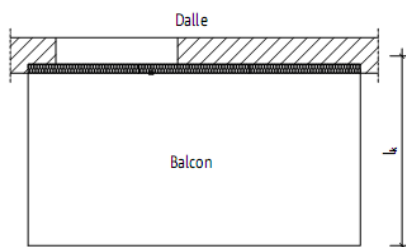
Balcon en béton armé en porte-à-faux.
